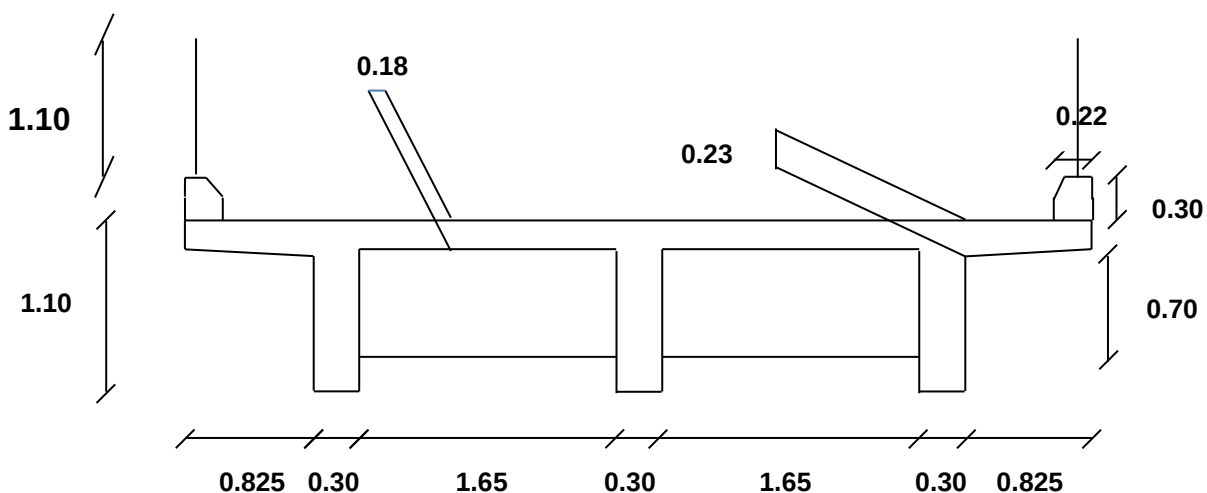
Sección Transversal del puente vehicular en la quebrada Toctehaicu, distancias en metros.
